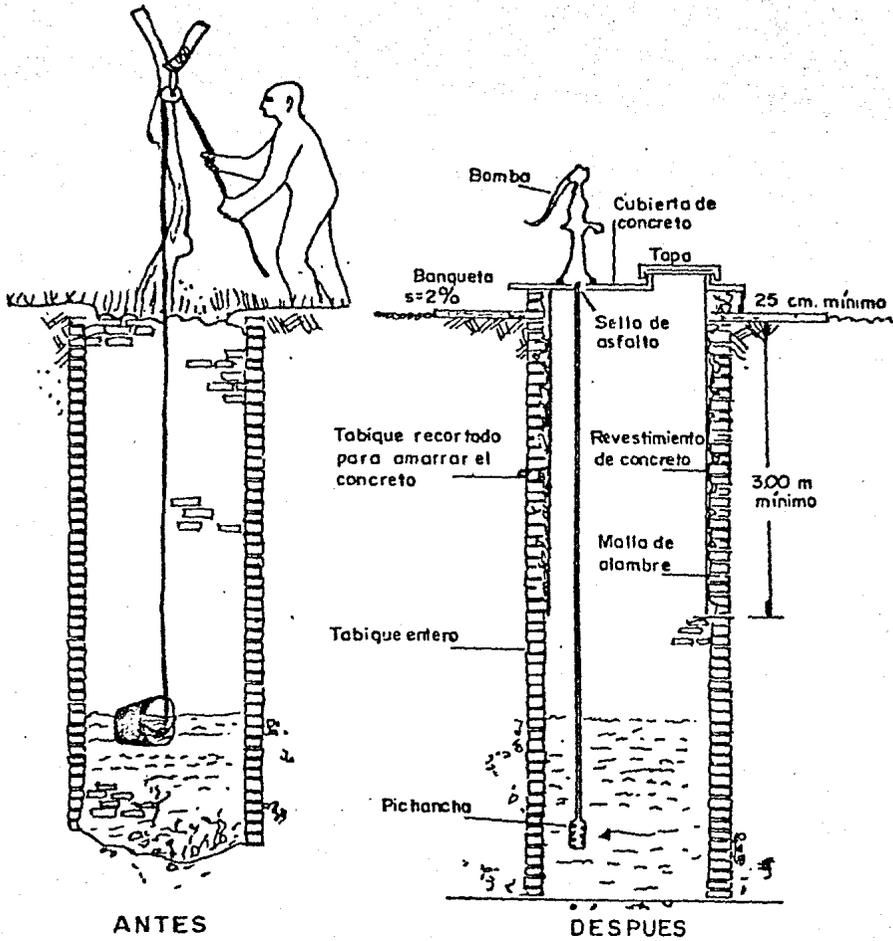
MEJORAMIENTO DE POZOS EXCAVADOS CON ADEME DE TABIQUE.
